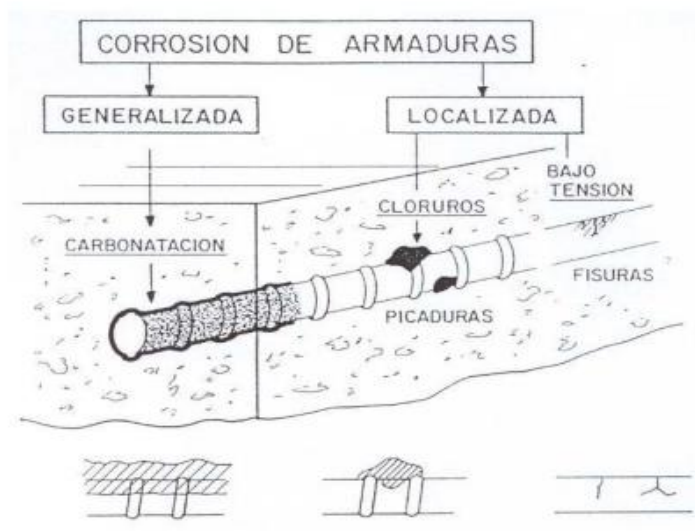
Tipos de corrosión en armaduras de concreto
